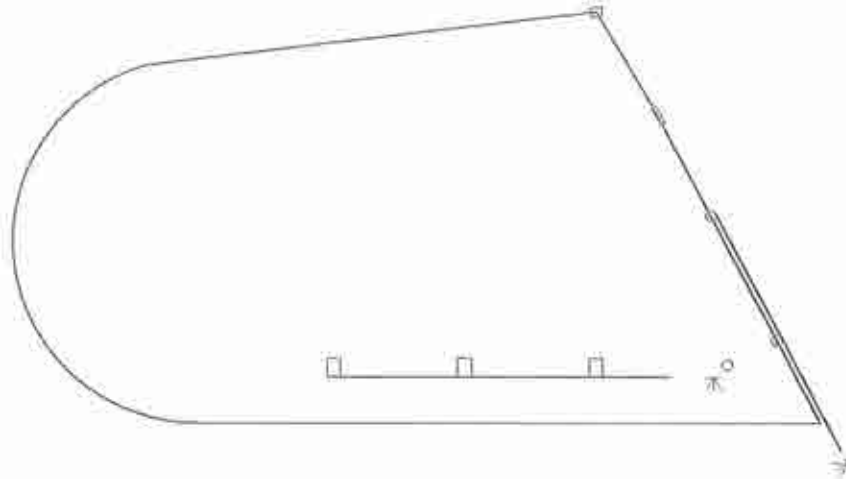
Vista en planta de las columnas ubicadas en la planta baja
